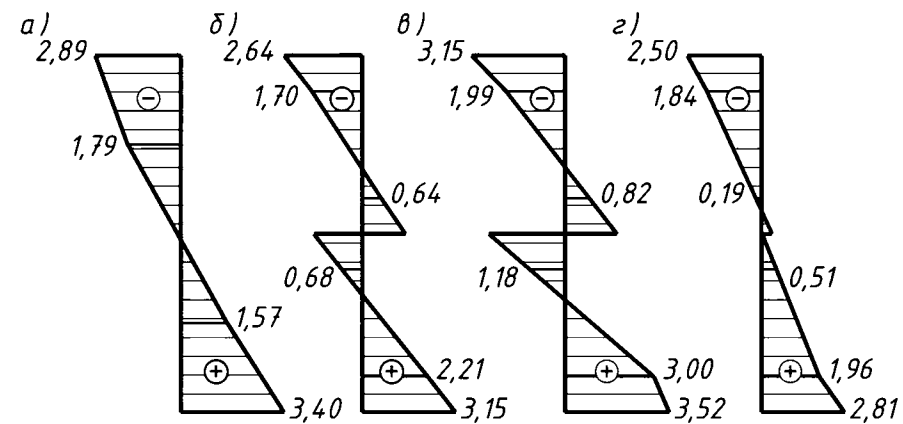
Распределение нормальных напряжений (МПа) по высоте поперечного сечения при нагрузке $F = 1$ кН: а – балка цельного сечения Б1; б – балка составного сечения на гвоздях Б2; в – то же на винтах Б3; г – то же на вклеенных стержнях Б4
